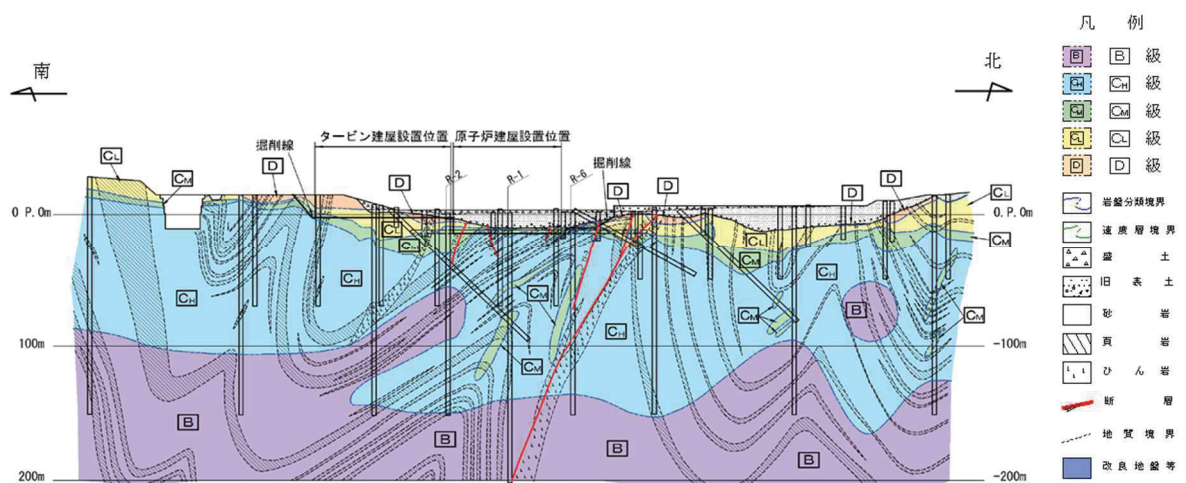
(2) 原子炉建屋の地質断面図 (②-②断面)
